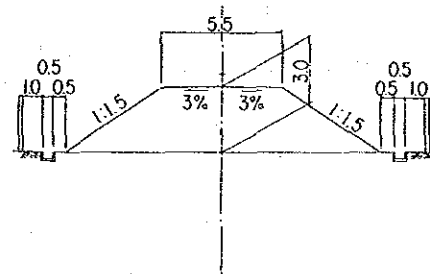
SECTION STANDARD DU DEBLAI ET DU REMBLAI
